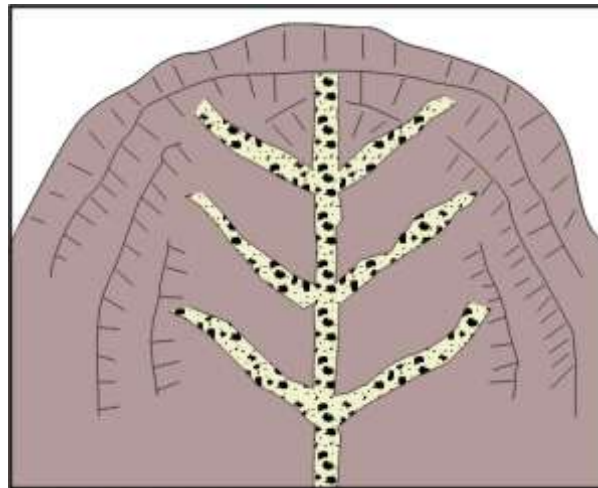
Esquema de planta de canales colectores espina de pescado con canales en gradería
